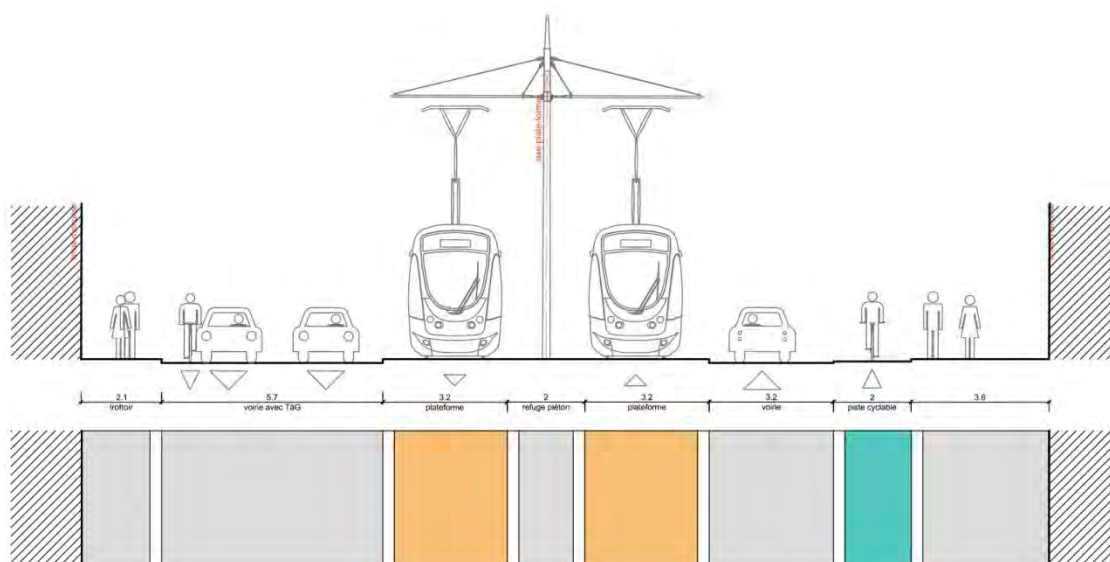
Coupe au droit d'une voie de tourner-à-gauche avec traversée piétonne
